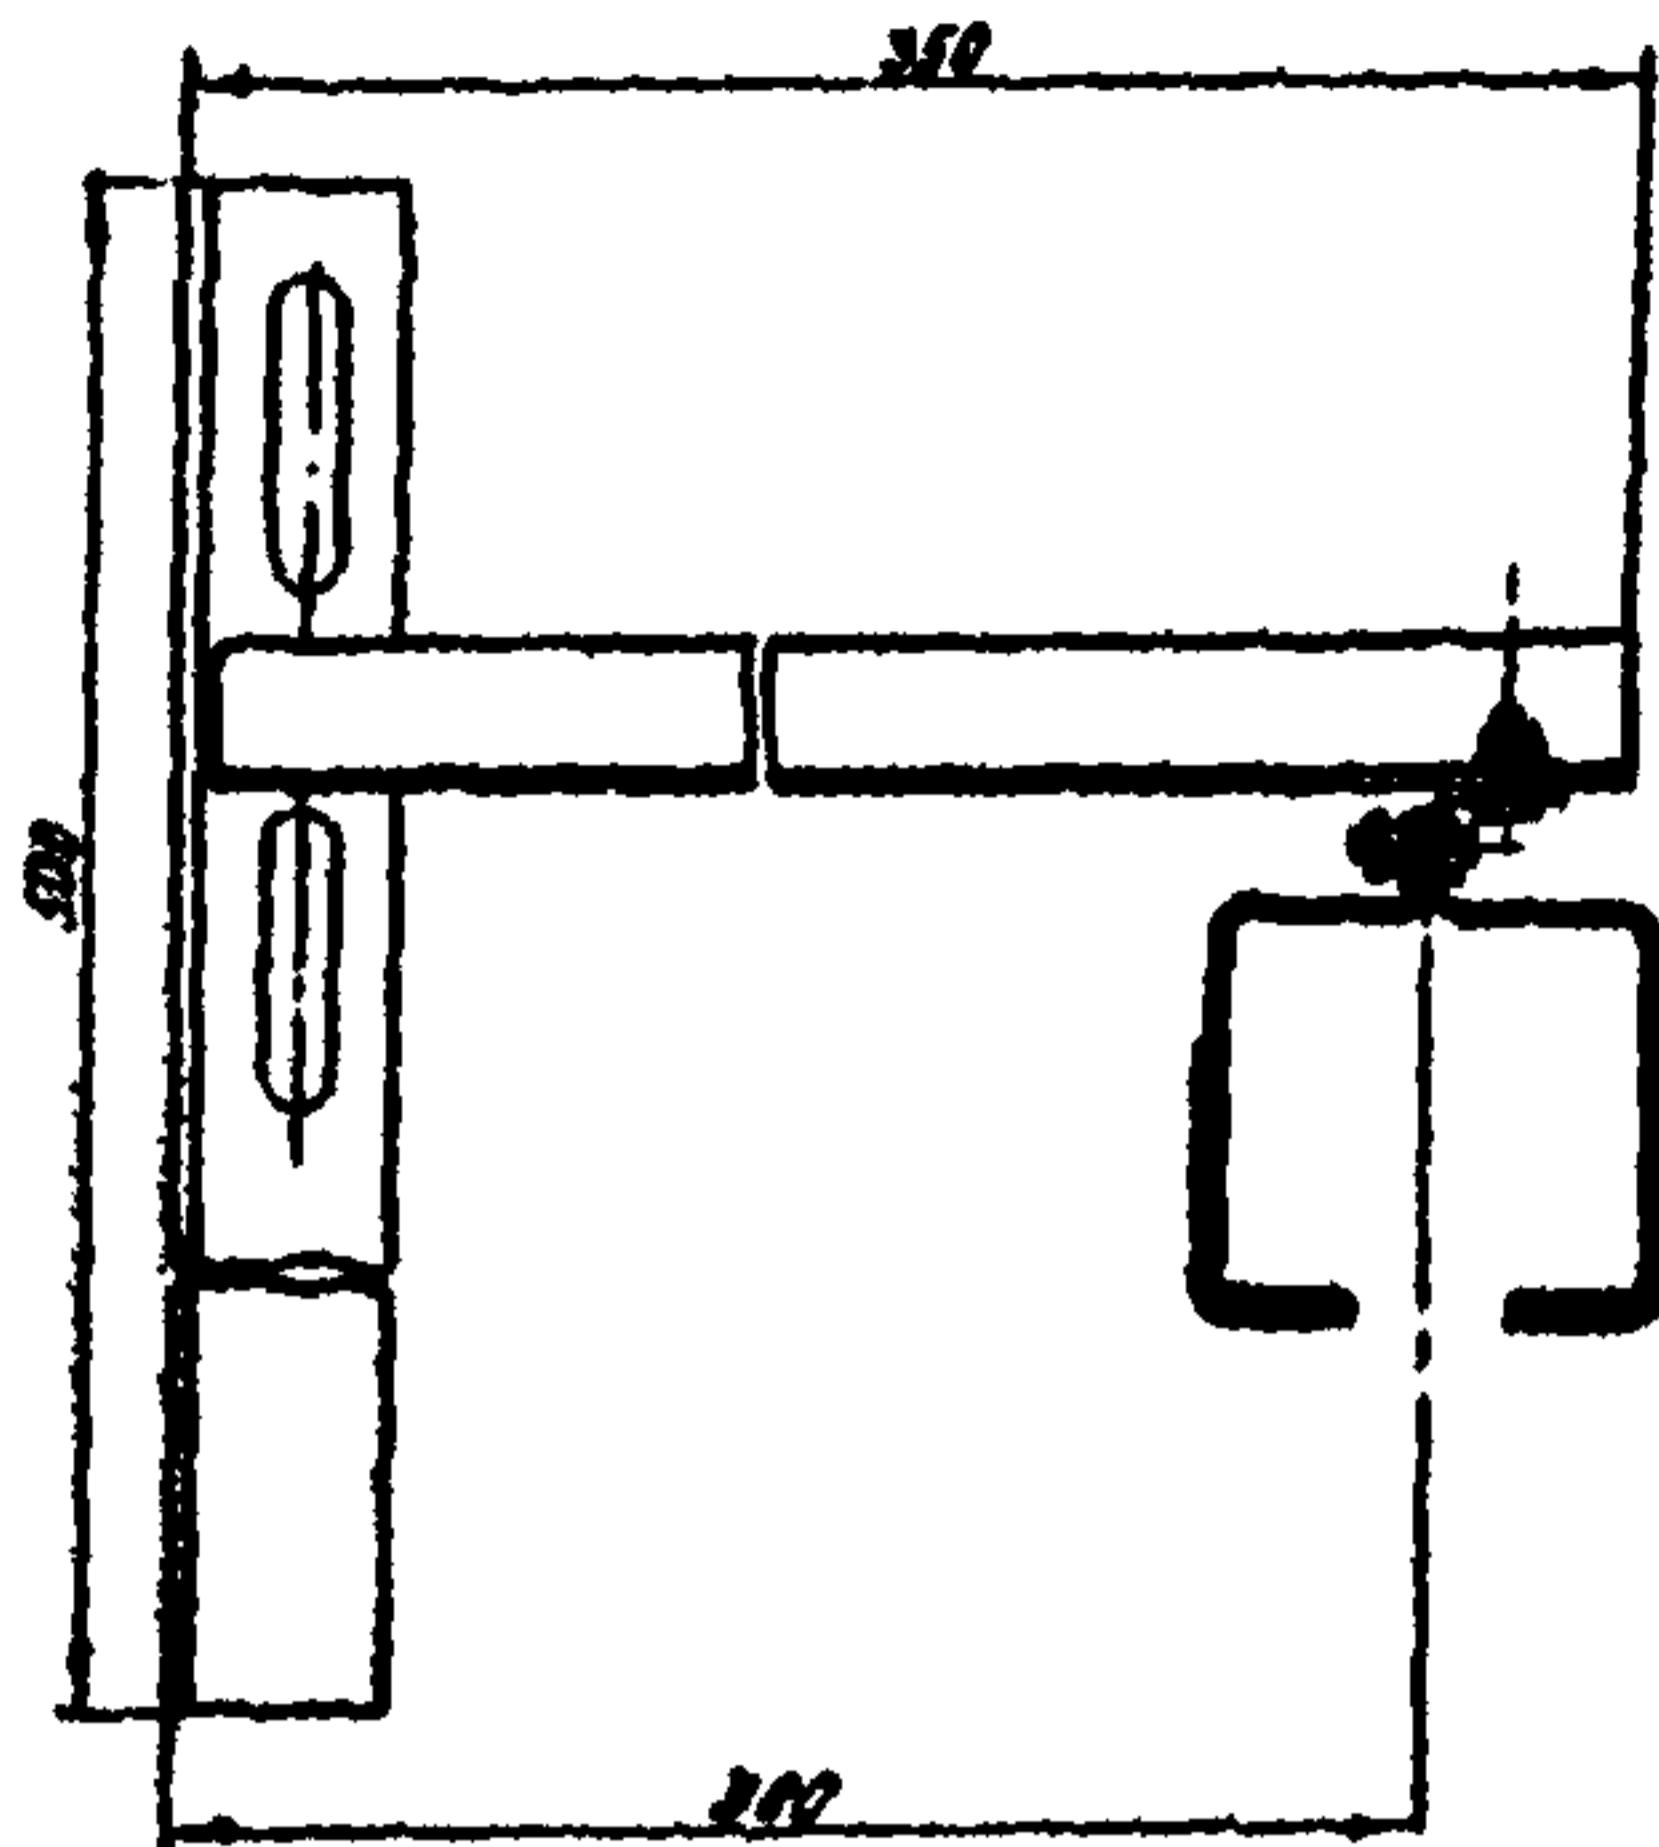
Кронштейн У2412 для крепления шинопровода ЦТМ 76 на стене, колонне.
